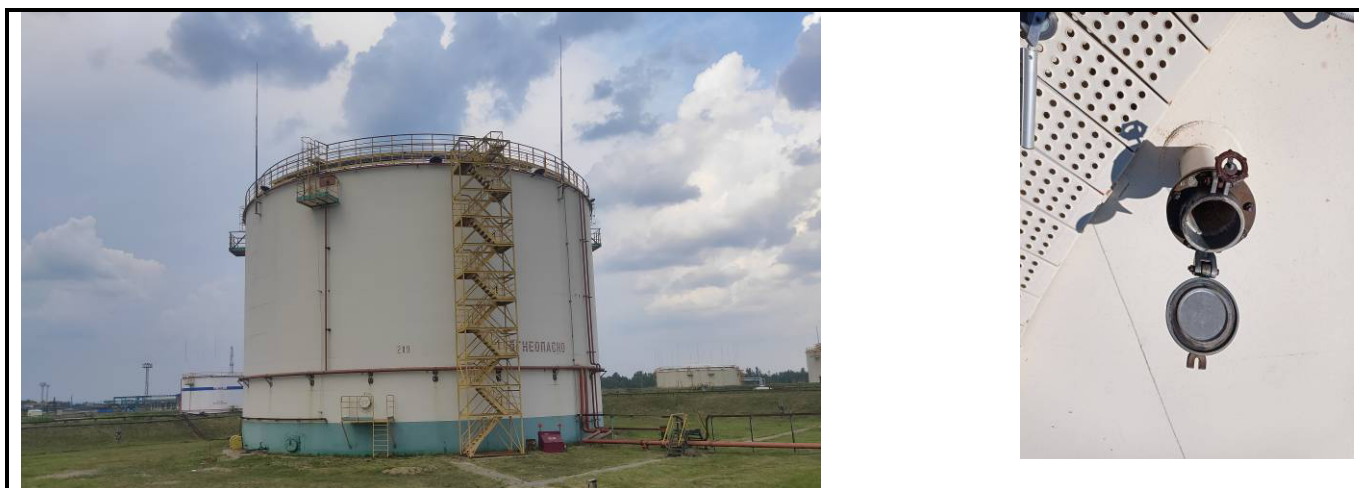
Общий вид резервуара РВСП-10000 (№219) с замерным люком
